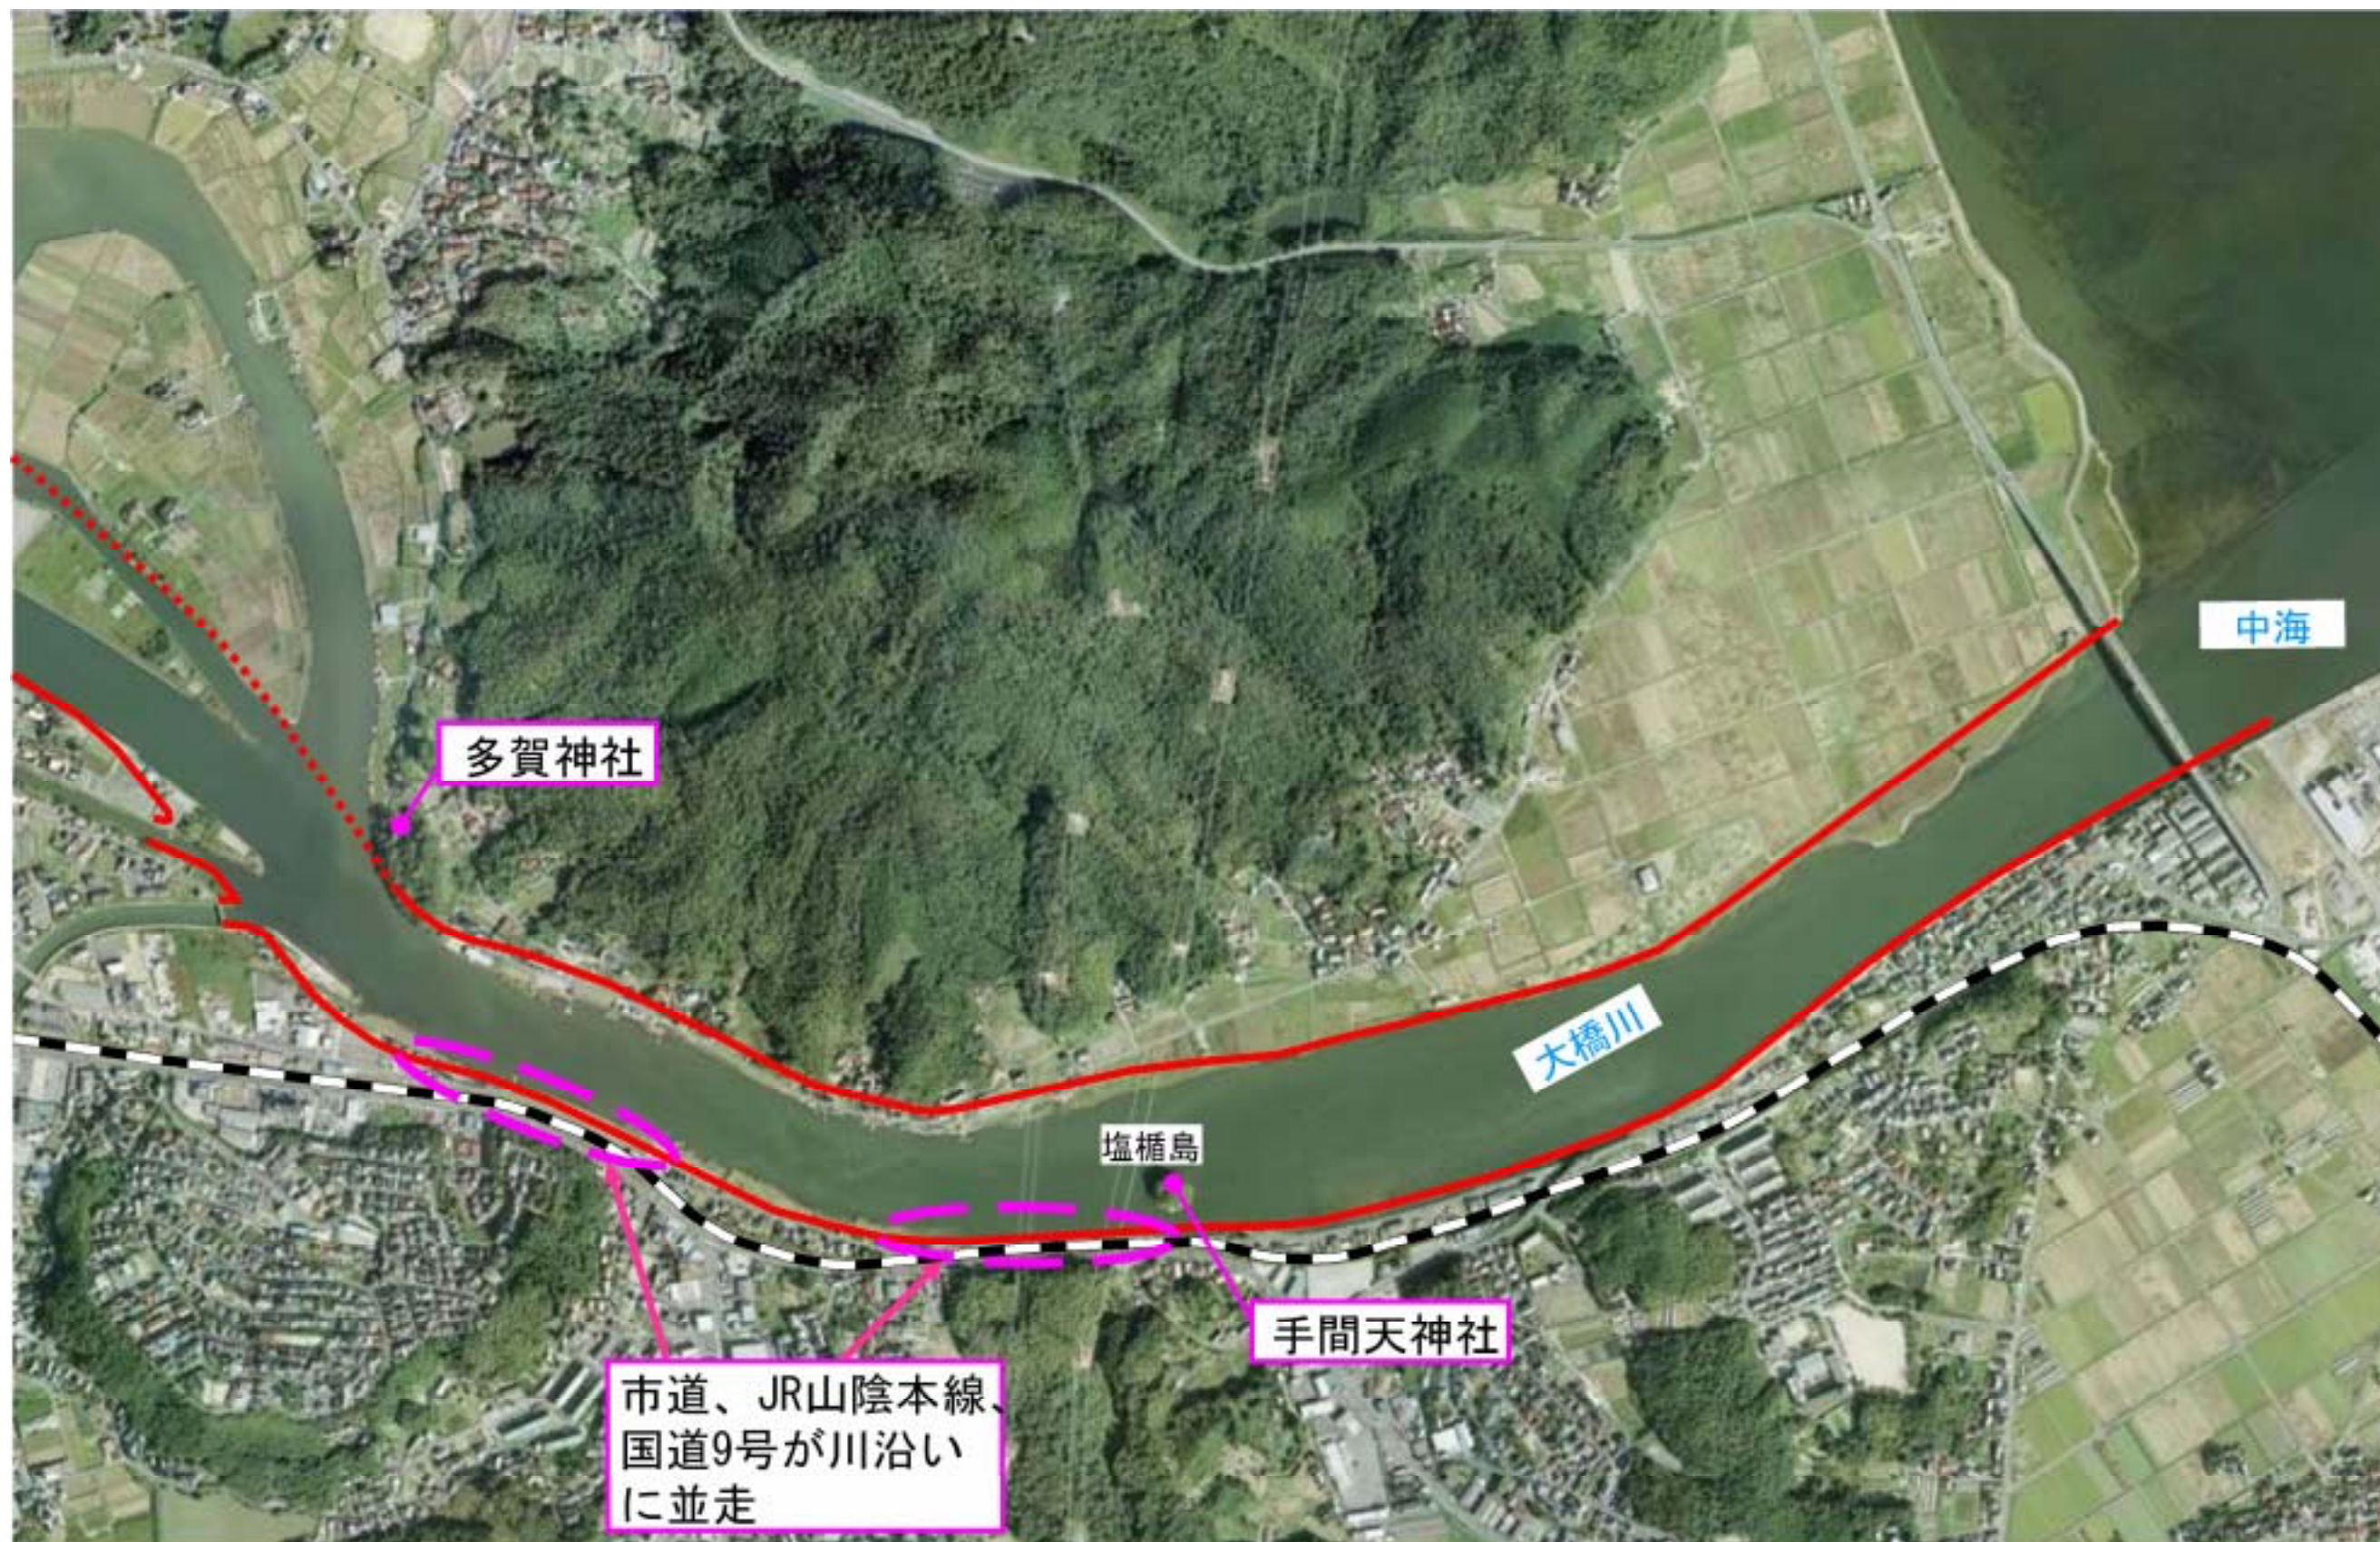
(1) 大橋川改修案の平面図(下流部)
